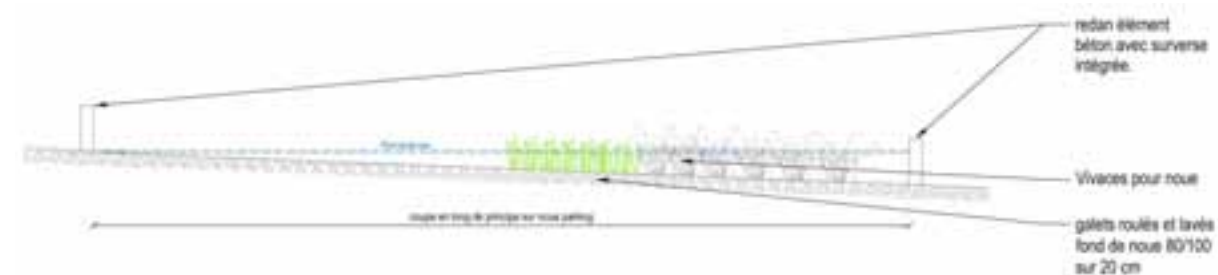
Principe de réalisation d'une noue sur les zones de parking - coupe longitudinale (Kéo, paysage et aménagement, septembre 2018)
